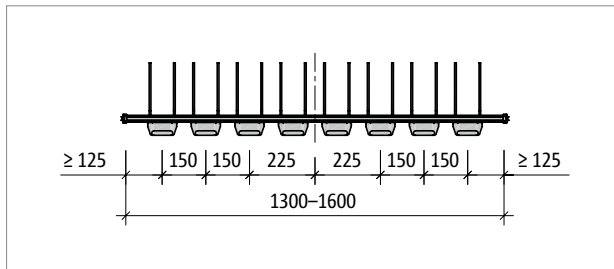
Tronsole® T-V8-...-L1300 bis L1600: Produktgrundriss
